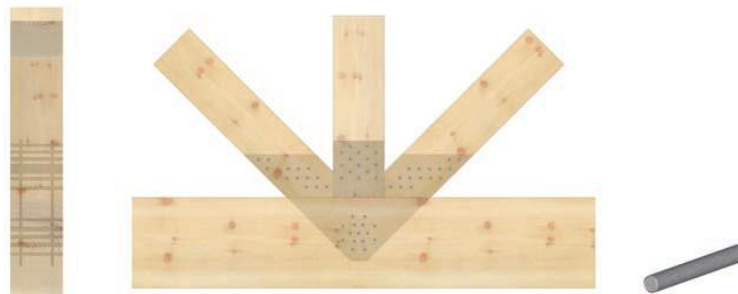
Conexión de viga triangular desarrollada con BLUMER SYSTE BINDER
